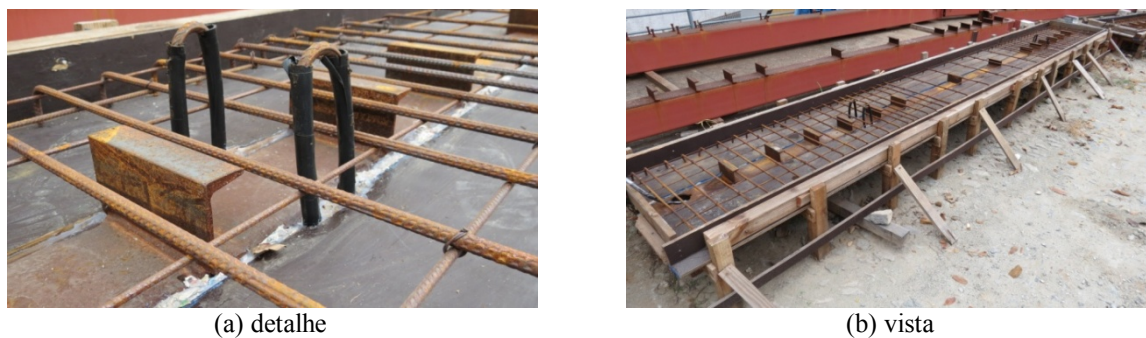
Ensaio de flexão: inserção da armação da laje sobre a fôrma
